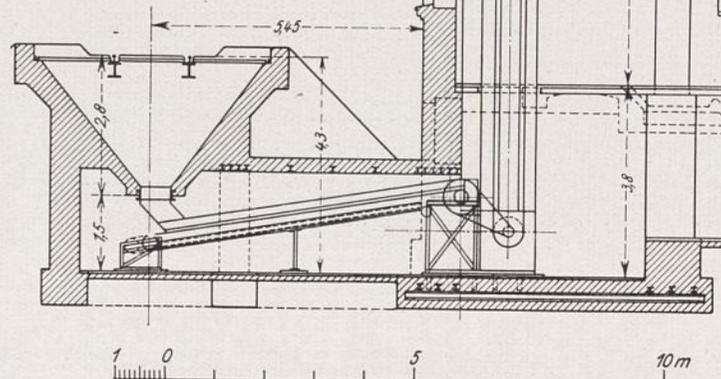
Kesselhaus, Schnitt durch den Elevatorturm.
